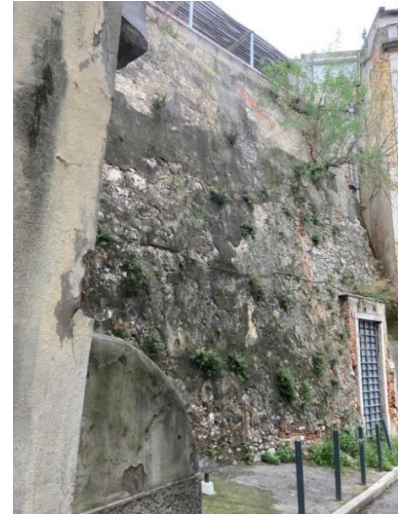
A – Muralha Noroeste do Baluarte do Livramento
